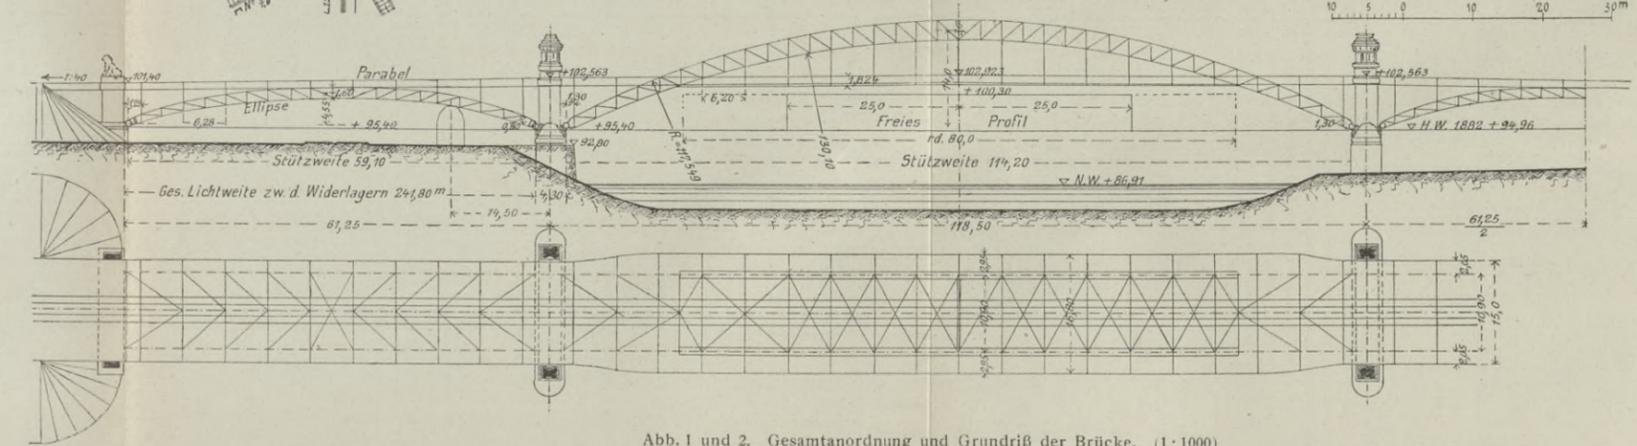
und 2. Gesamtanordnung und Grundriß der Brücke. (1:1000)
